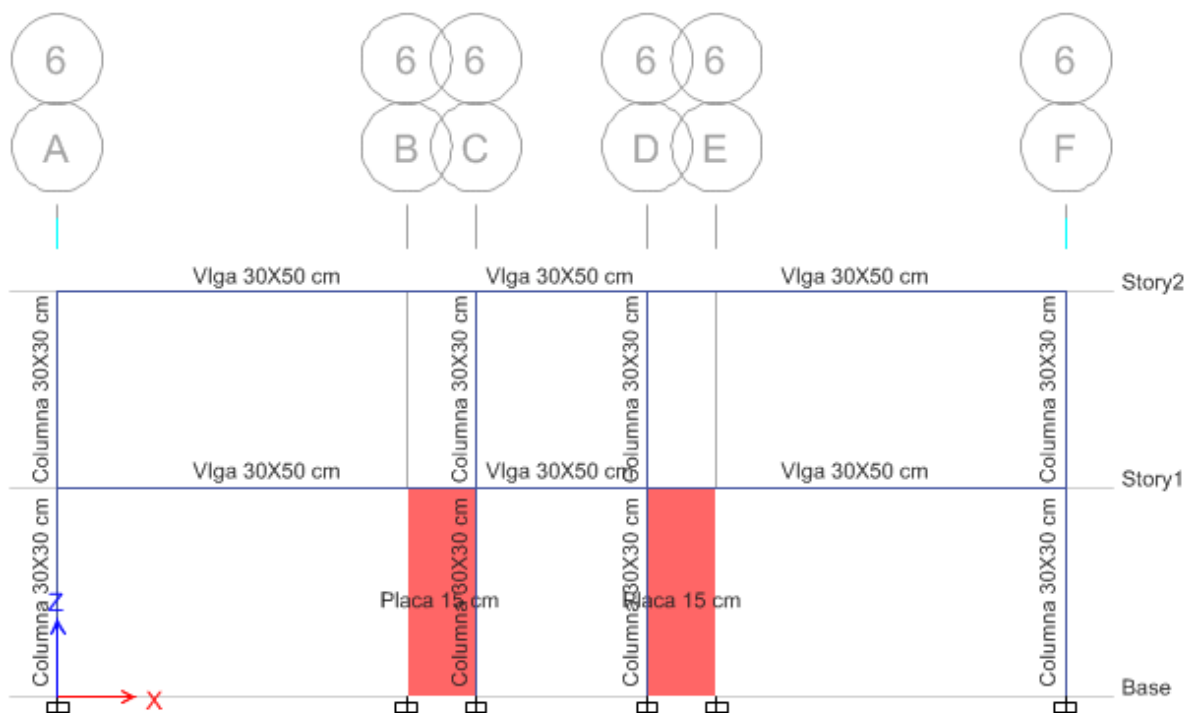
Refuerzo estructural con placas de concreto armado de 15 cm en el eje 6.
